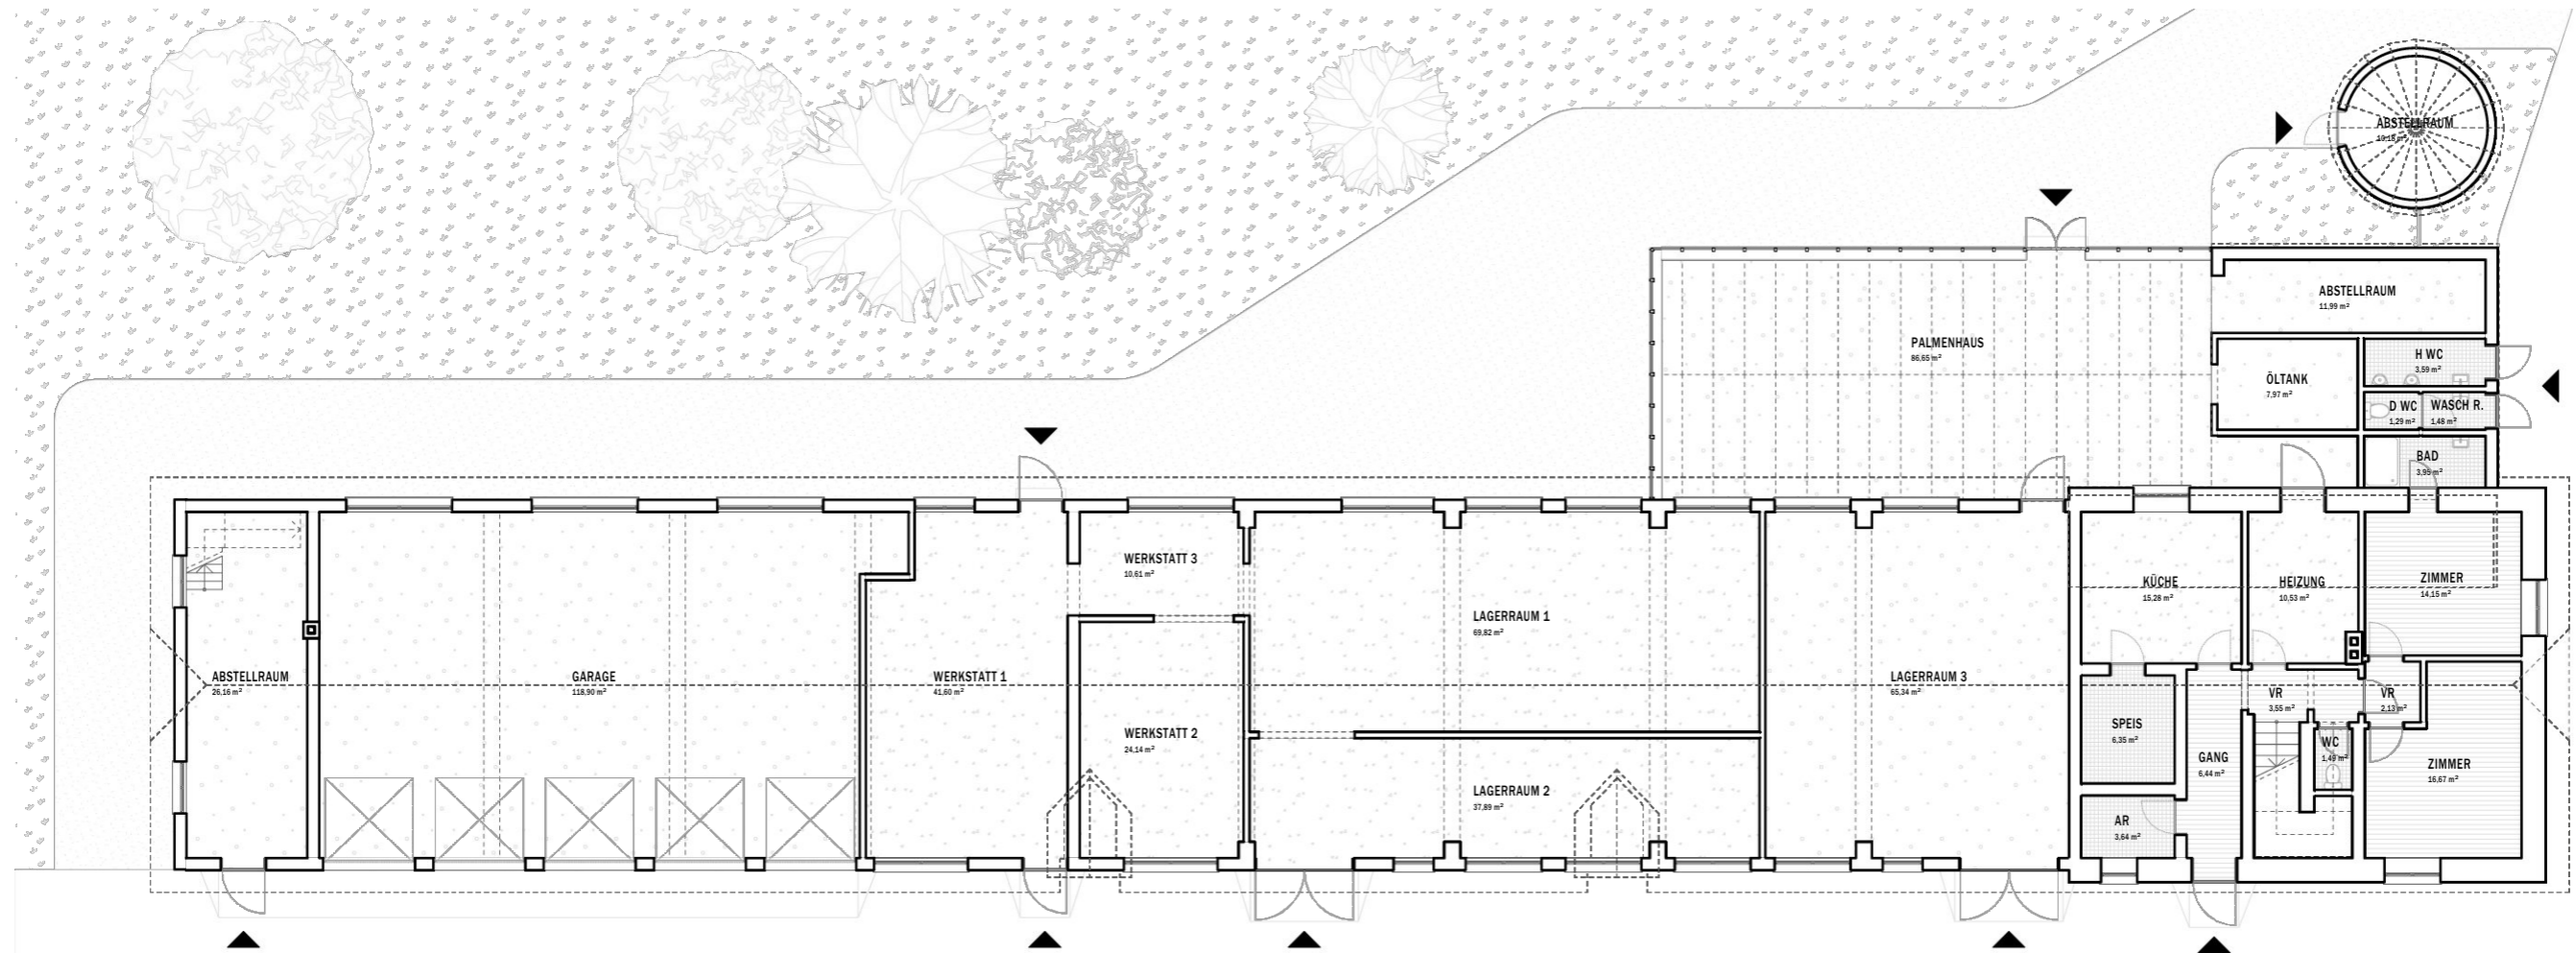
Grundriss EG, Stallgebäude
